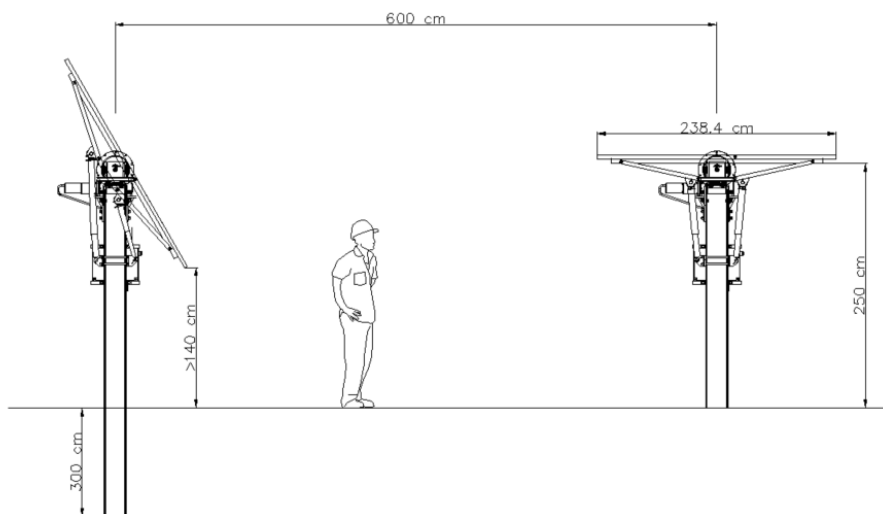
Sezione tipica strutture modulari (fonte: Tavole progettuali)
